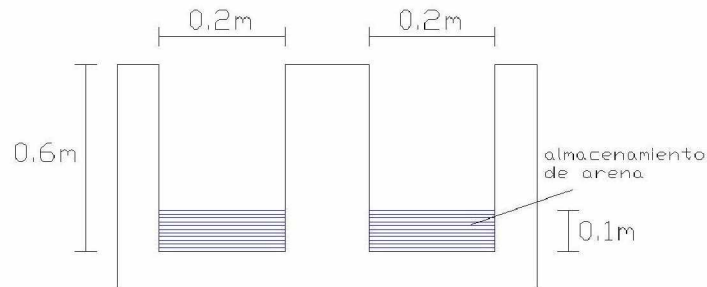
Sección transversal del desarenador para la Planta N°3
